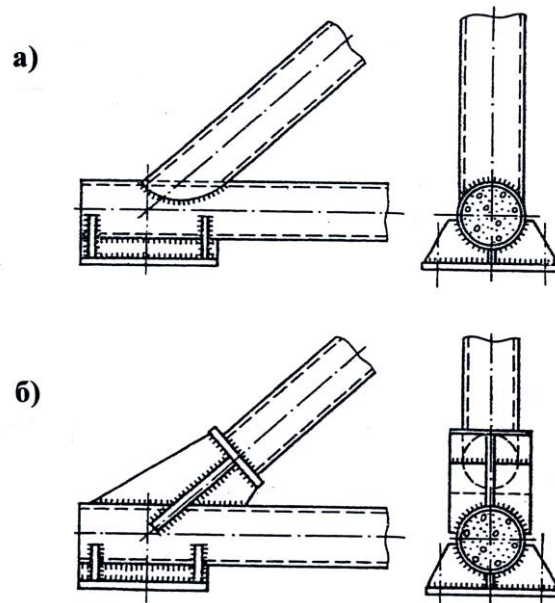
Узлы опирания трубобетонных ферм: а) при непосредственном соединении опорного раскоса с нижним поясом, б) при соединении с помощью фасонки [3]
